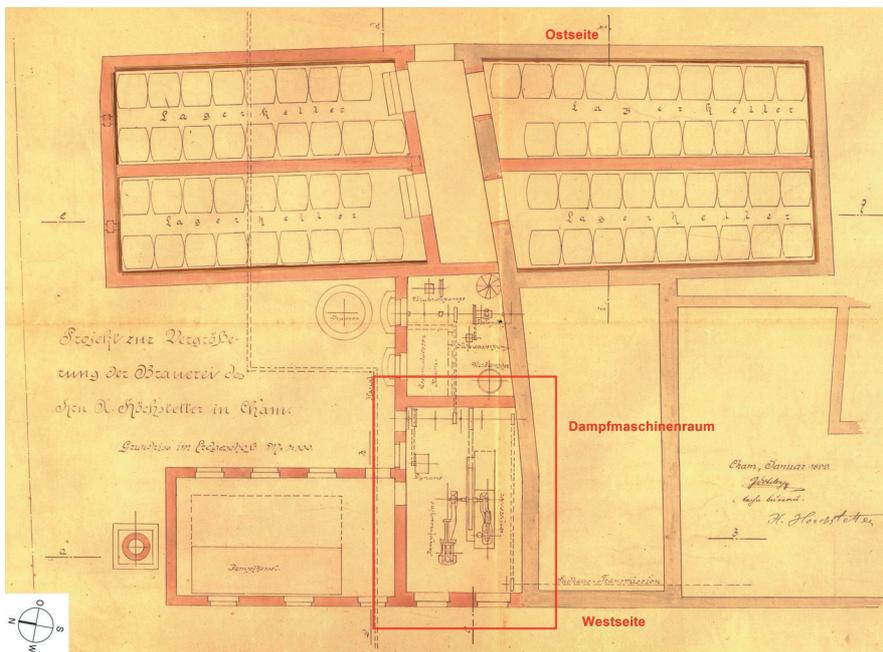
EG-Grundriss des Brauereianbaus mit Dampfmaschinenraum (rot markiert) aus dem StAAm/Bezirksamt Landratsamt Cham, Baugenehmigungsakte 8/1899 (Anbau und Einbauten sind rot eingefärbt)
